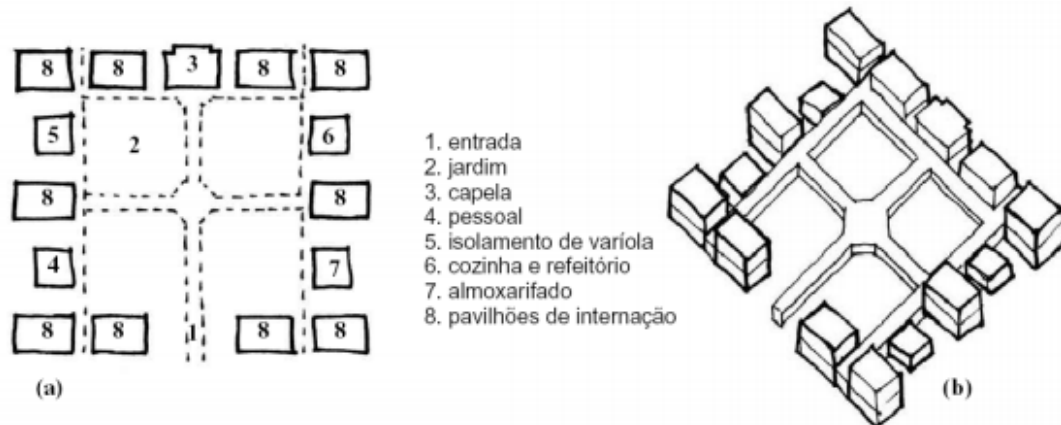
Royal Naval Hospital, Inglaterra. (a) planta; (b) croqui.
